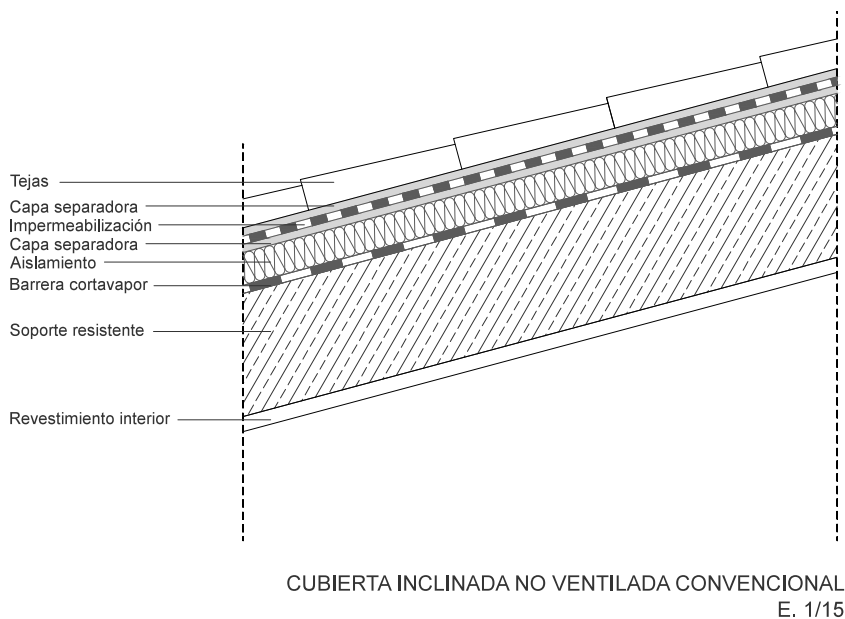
Detalle cubierta inclinada no ventilada convencional
